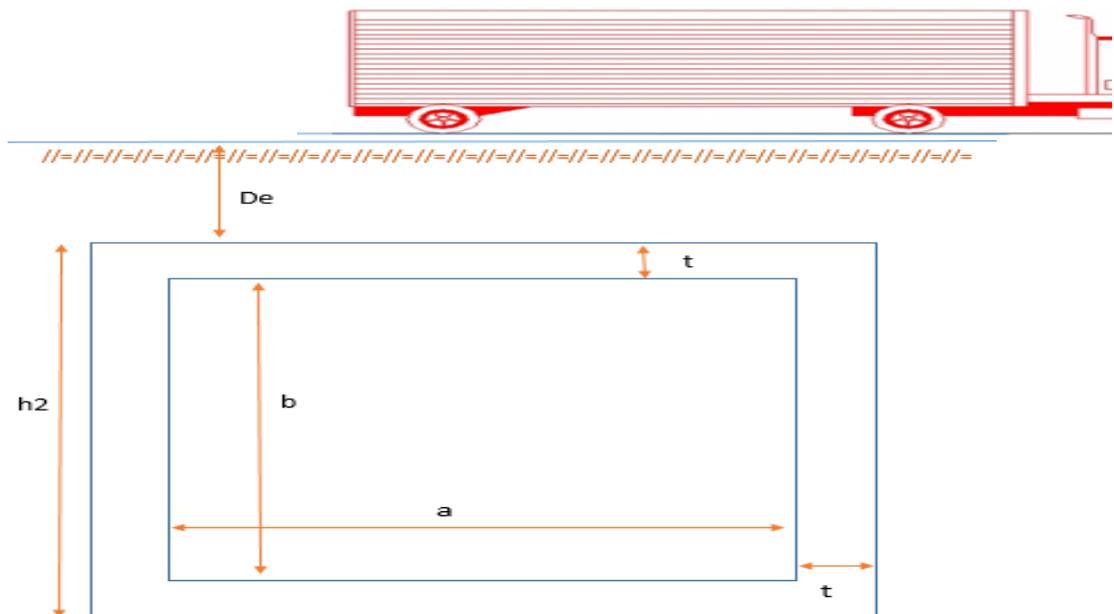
Sección del paso peatonal tipo alcantarillado.
